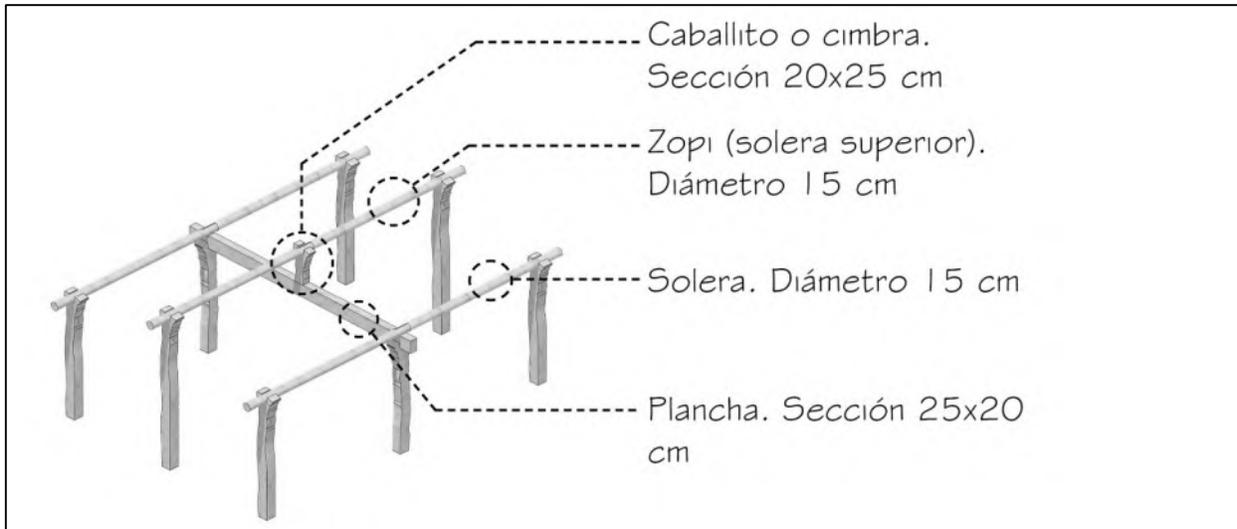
Procedimiento constructivo de la casa de barro: colocación de soleras, plancha y caballito. Fuente: elaboración propia.
